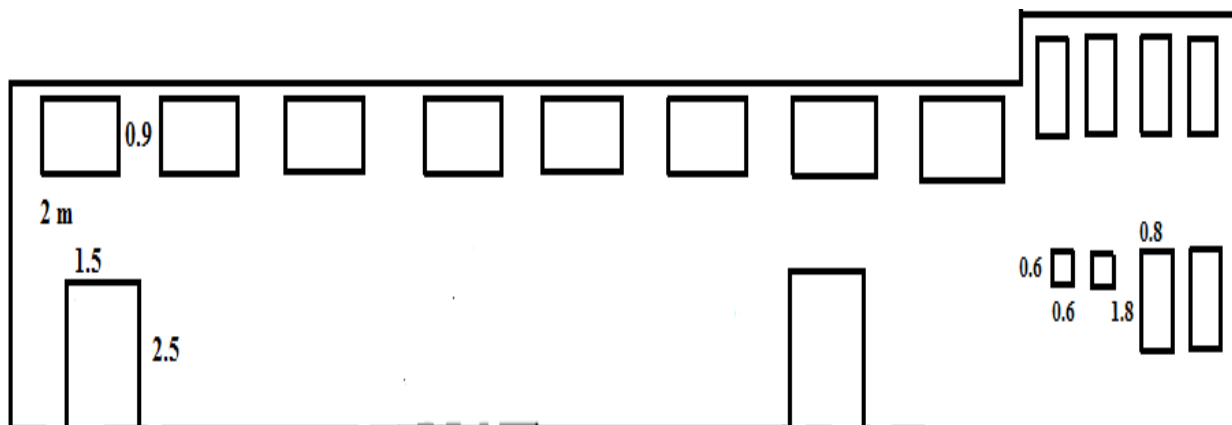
Surfaces des ouvertures sur la façade latérale droite.
